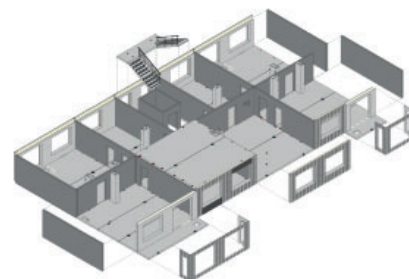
Конструктивная схема с плитами перекрытия с предварительно напряженной арматурой. Варианты решений по балконам
